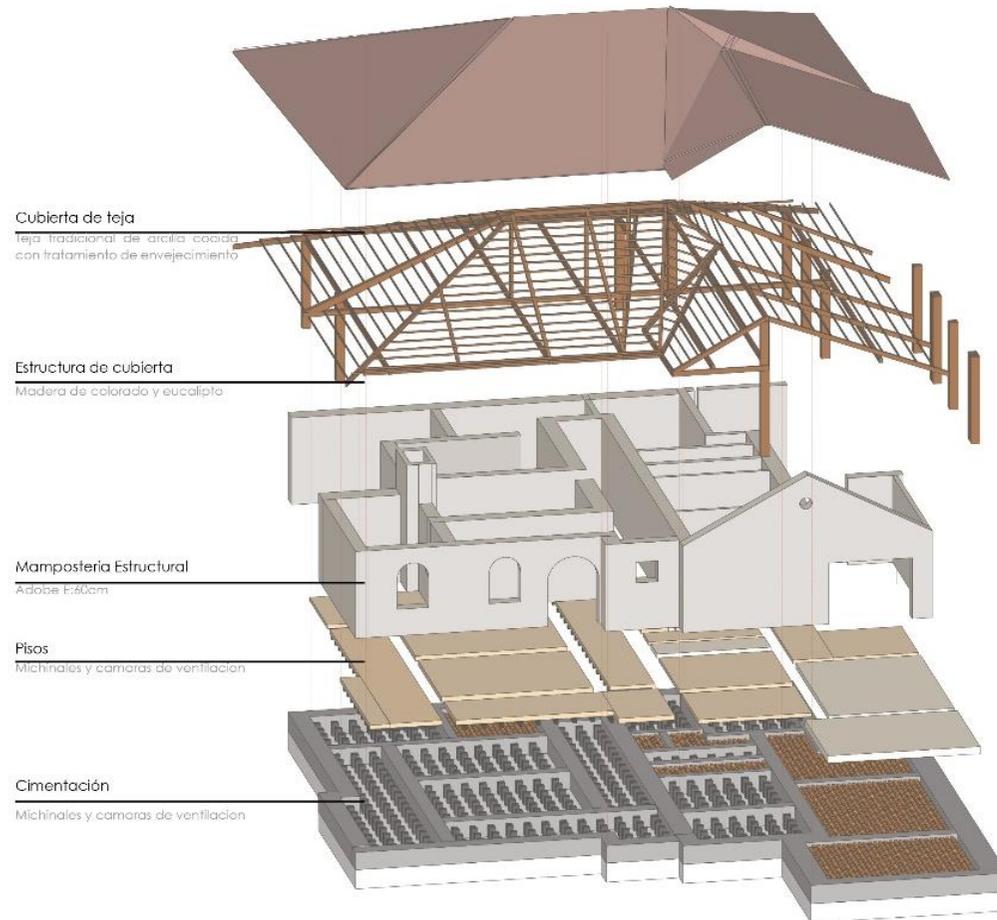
isometría de sistema constructivo de casa hacienda Cariacu
